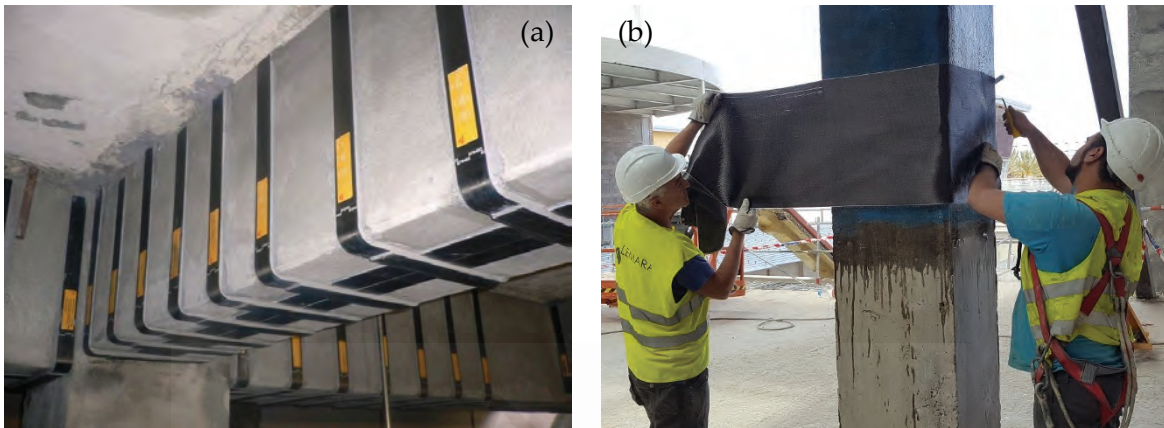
Refuerzos a flexión y cortante en vigas de hormigón con laminados prefabricados (a) (Sika) y detalle de ejecución del refuerzo de un pilar por confinamiento mediante tejidos de fibras de carbono aplicados in situ (b) (Lemara Restauraciones, S.L.).
